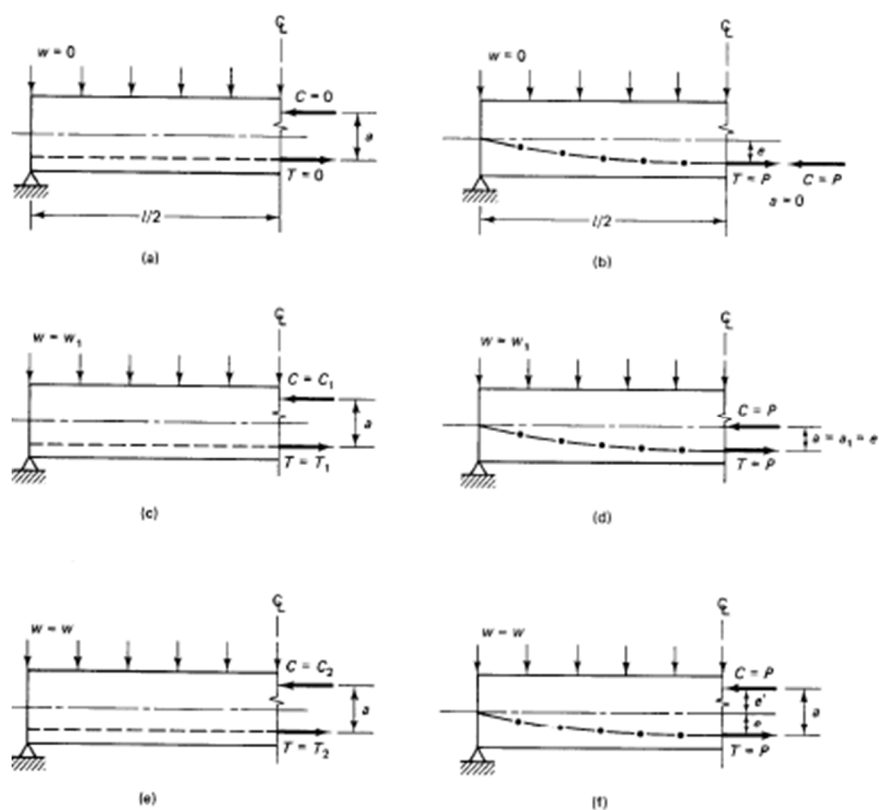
Diagramas comparativos de cuerpo libre de una viga de hormigón armado y una viga de hormigón pretensado. (a) Hormigón armado sin carga (b) Hormigón pretensado sin carga (c) Hormigón armado con carga w_1 . (d) Hormigón pretensado con carga típica w_1 . (f) P.C. haz con carga típica w . Fuente: Prestressed Concrete 5ta. Edición – Edward G. Nawy. Página 14.
